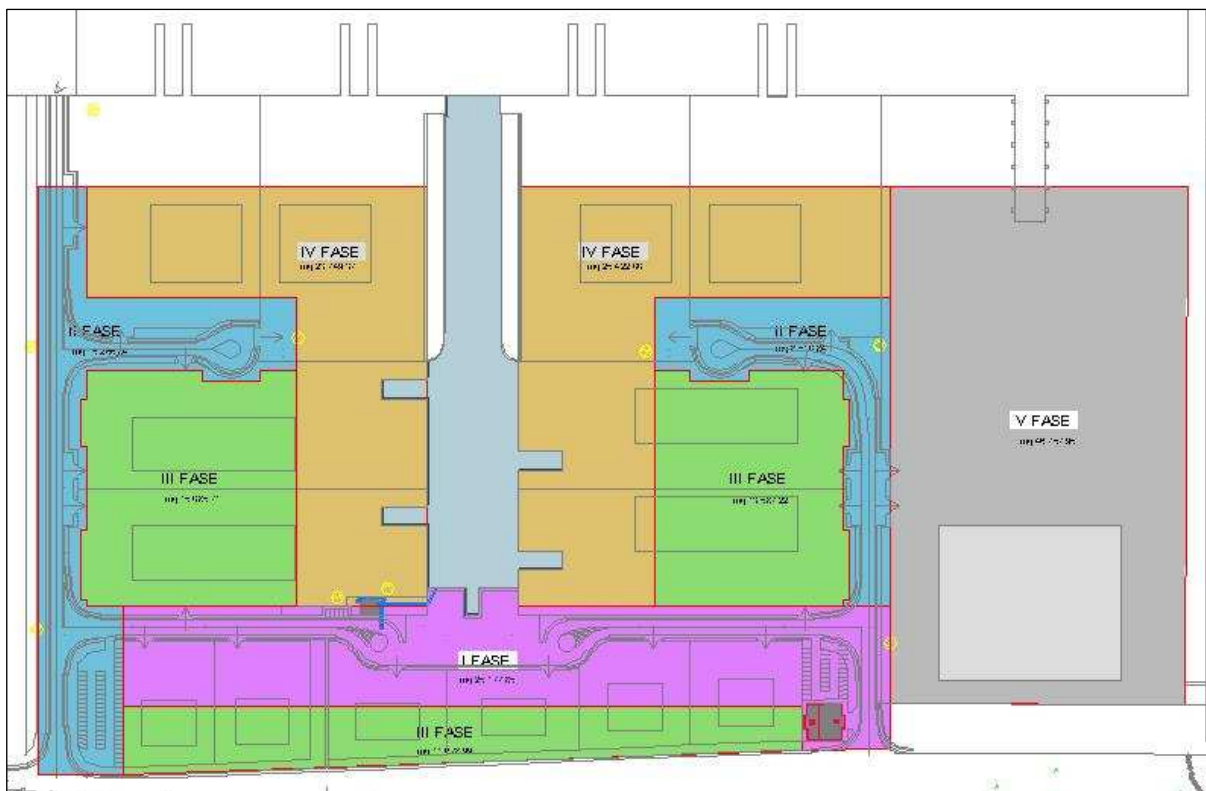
Planimetria di progetto con indicazione delle fasi previste.
